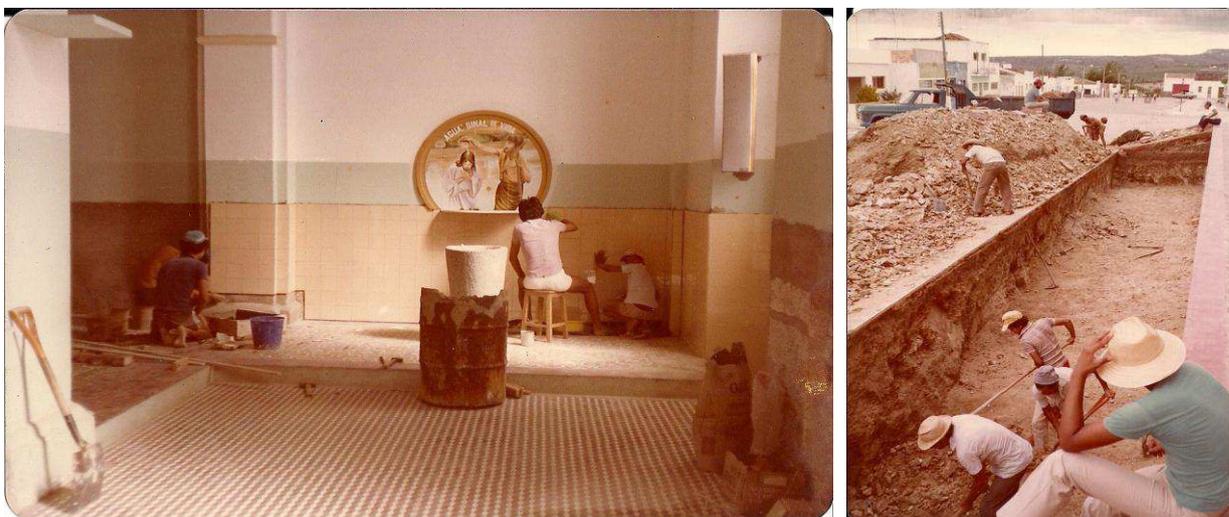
Construção da Paróquia de Nossa senhora da Conceição. Fonte - arquivo paróquia Nossa Senhora da Conceição.
